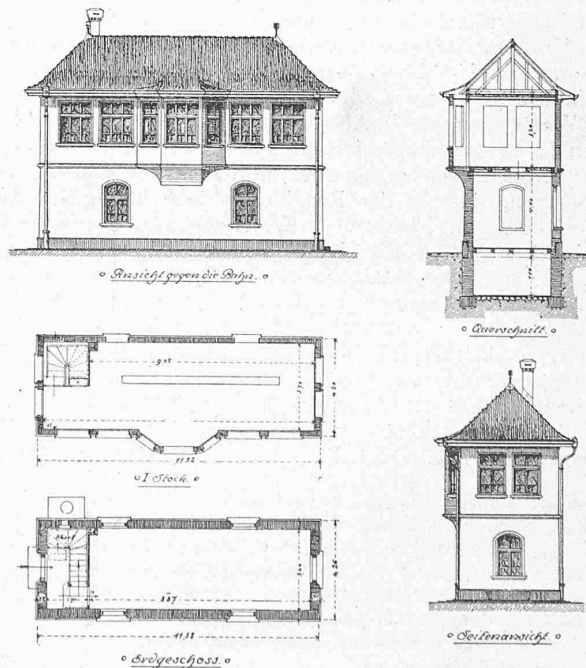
Stellwerkhäuschen der S. B. B. im Bahnhof Baden. Ansichten, Grundrisse und Schnitt.
